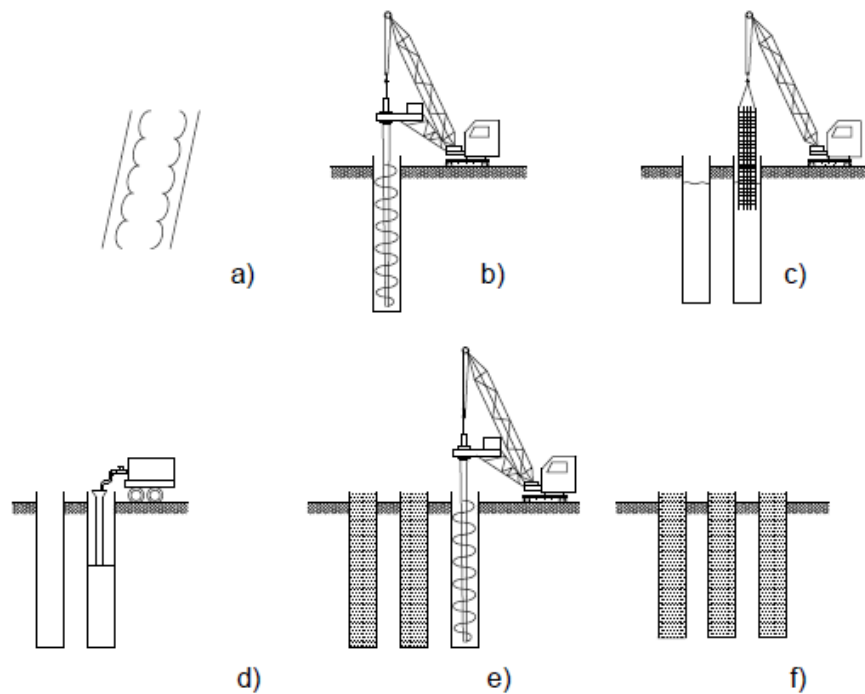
Proceso constructivo de pantalla de pilotes separados y tangentes: a) Colocación de plataforma guía, b) Perforación del terreno, c) Colocación del terreno, d) Vaciado de concreto, e) Perforación del siguiente pilote, f) Pilotes terminados (Fuente propia, 2015)
